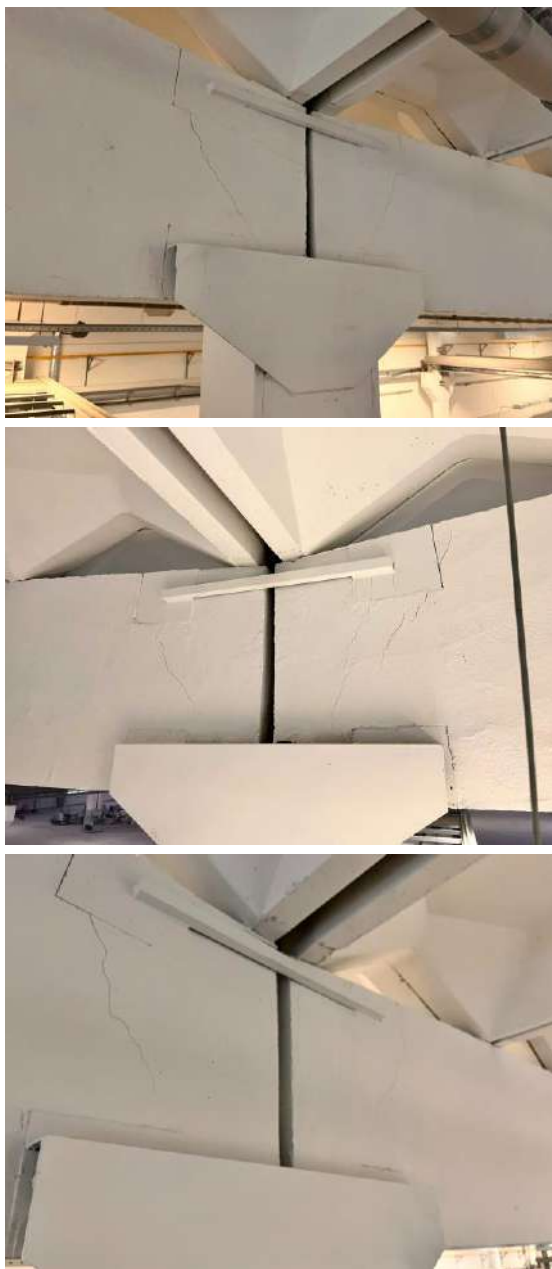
Сквозные трещины в верхней части опор стропильных балок
